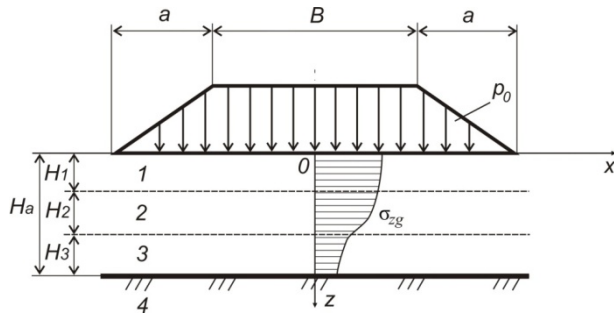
Расчетная схема слабого основания насыпи для расчета осадки и консолидации
